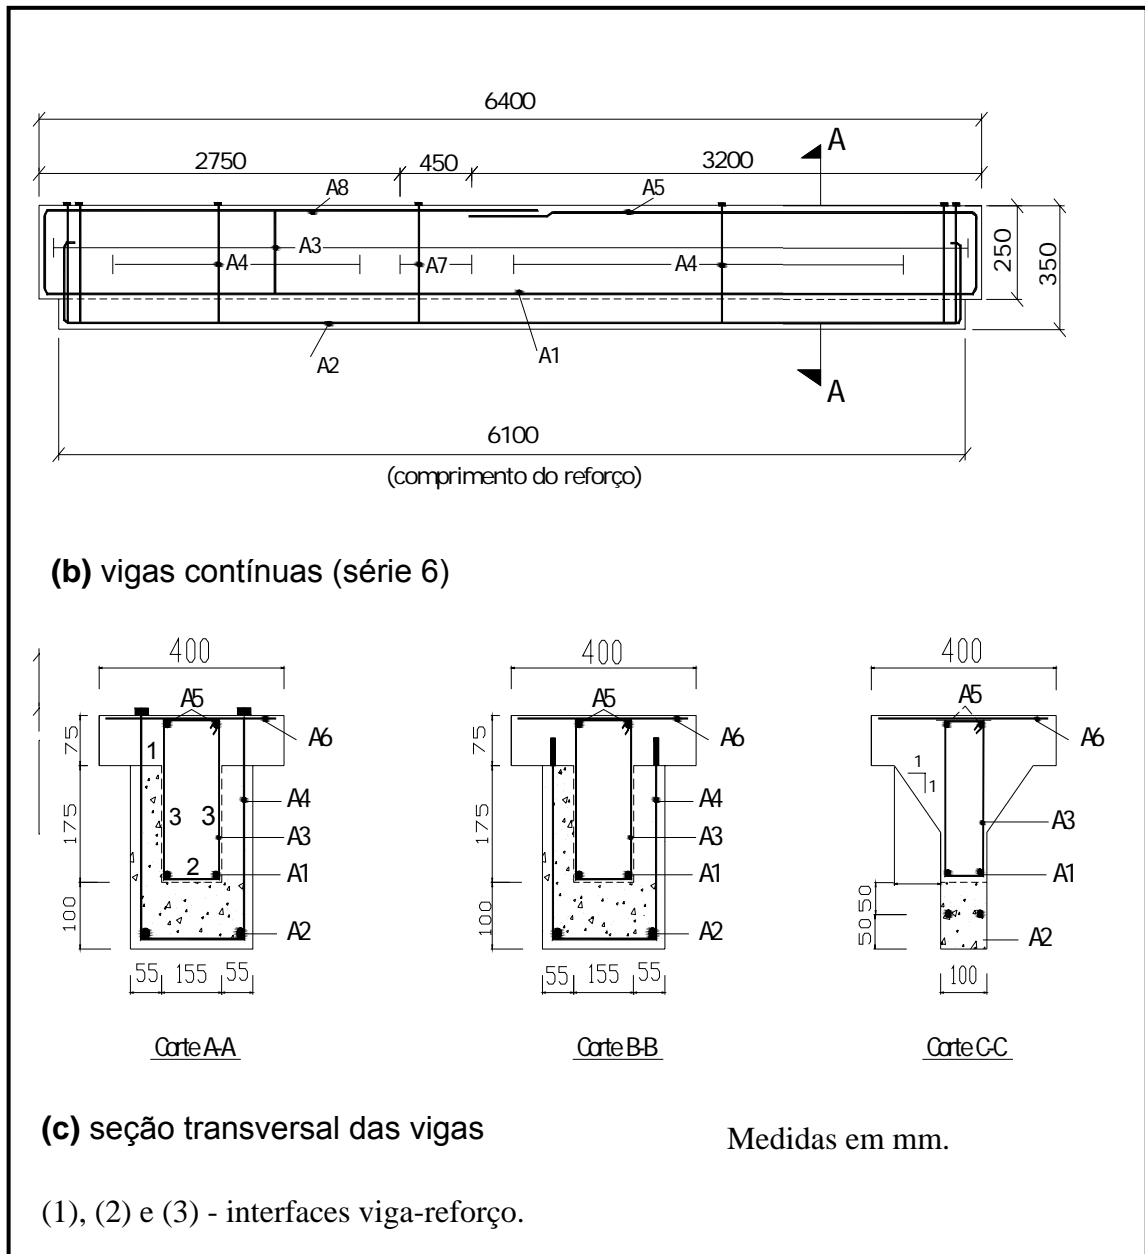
Armadura das vigas de CHEONG e MACALEVEY (2000)
